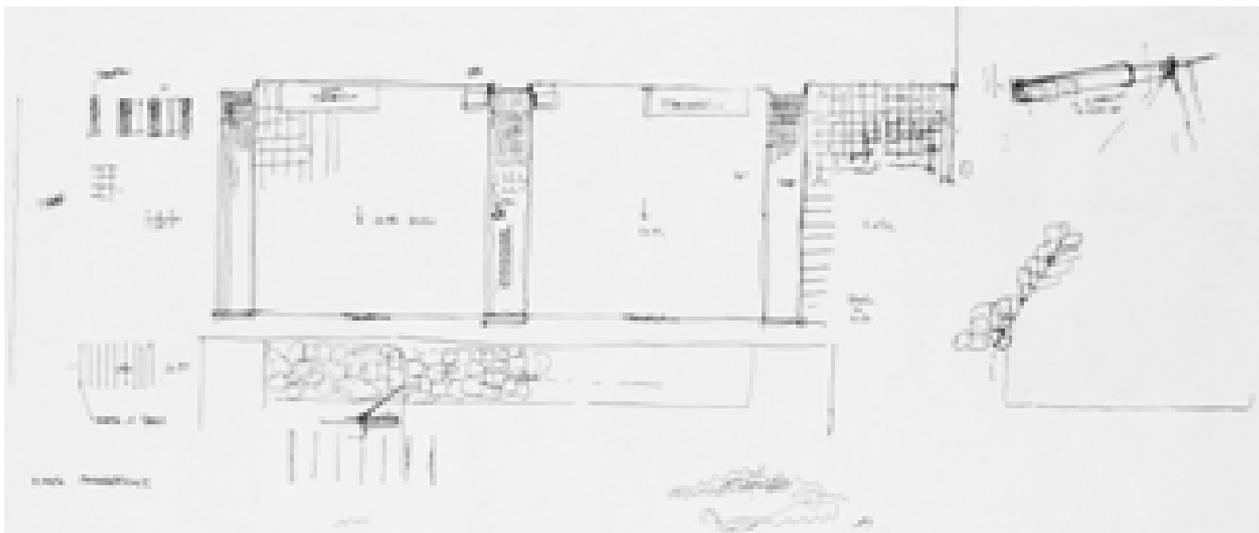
Studio pianta pavimentazione – progetto del 1997 (AABS-95.226)
